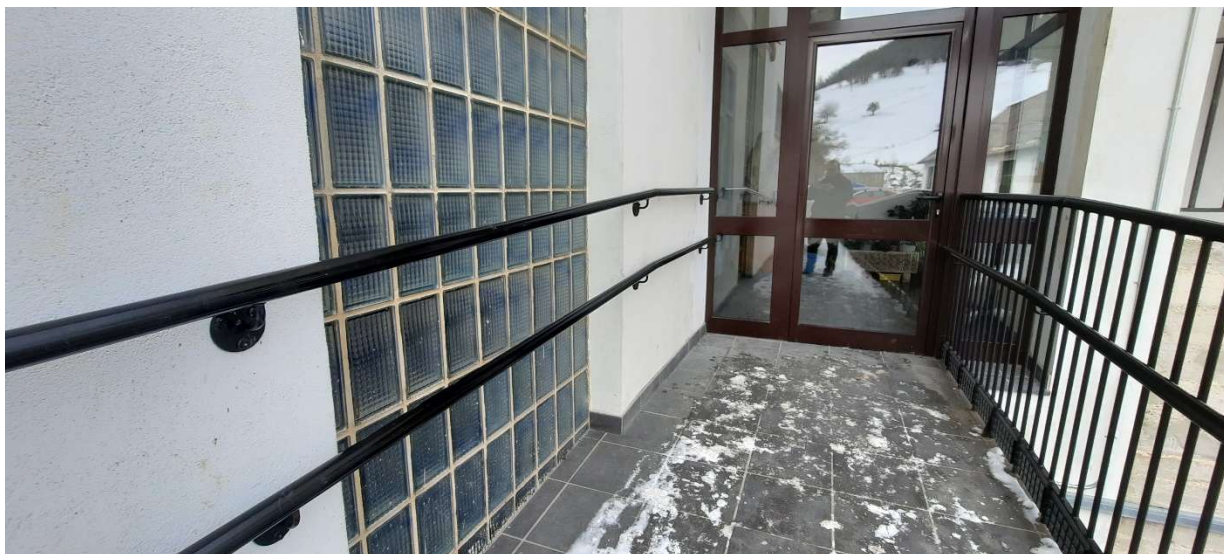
y 35 - Acceso a edificio y detalles rampa accesibilidad.
